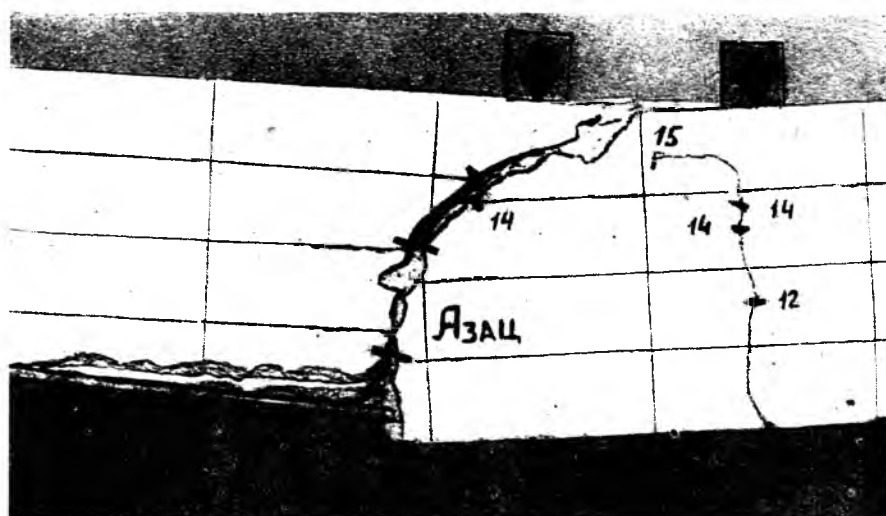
Разрушение по наклонному сечению балки из песчаного бетона без поперечной арматуры
